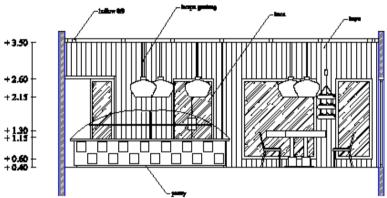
Denah Ruang Terpilih 3 (Area Makan Indoor)
